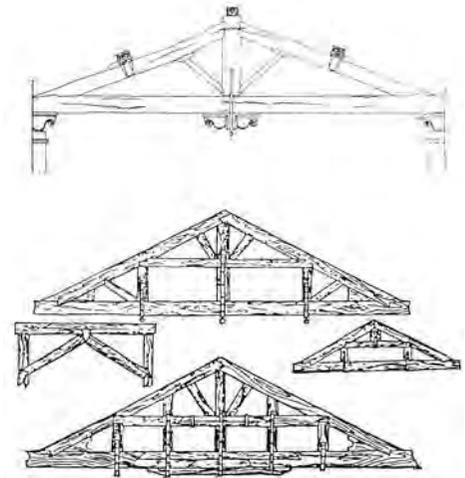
Hängewerke für Dächer, frühes Mittelalter /2/
